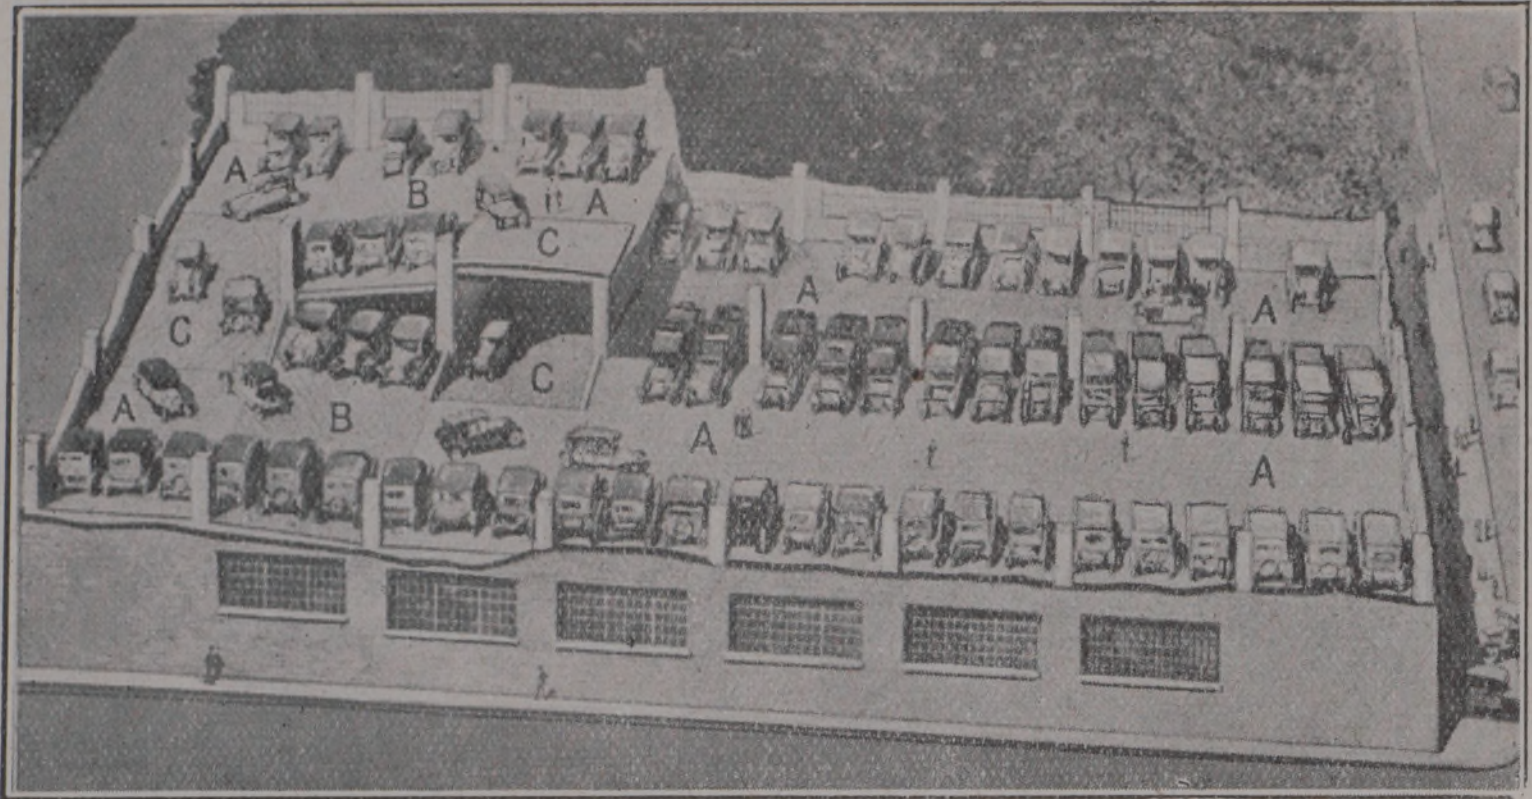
Fig. V. — Vue schématique d'un garage système United Storage Floor, coupe partielle. — Ce garage, d'un système analogue au précédent (fig. IV), possède une rampe qui monte très rapidement au moyen de plans inclinés égaux B et C. Les voitures sont garées sur cette rampe en B et sur les paliers en A. La pente de la rampe est de 8 à 9 p.c. On constatera que les voitures garées en B sont dans une position tout à fait anormale.
